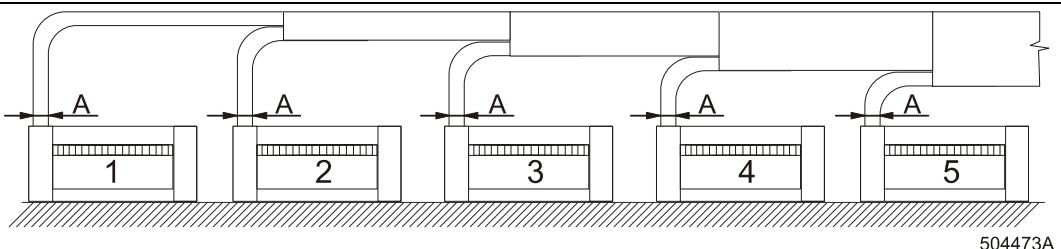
С Трубопровод вентиляции для группы гладильных машин
